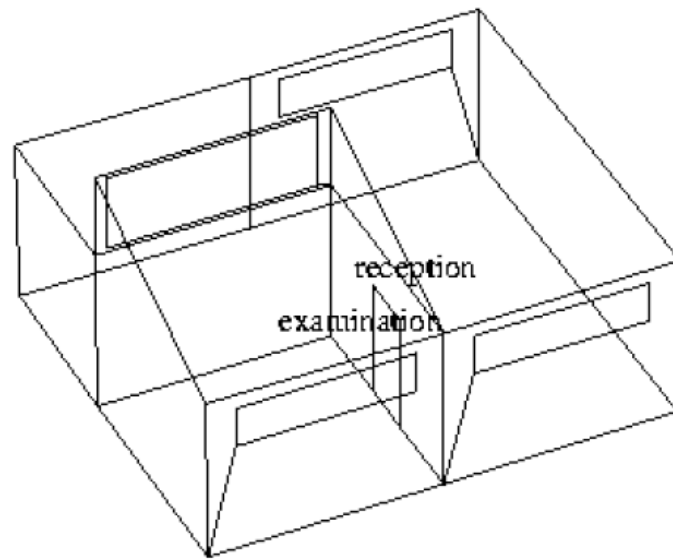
Vista prospettica in *wireframe* dell'ufficio.
